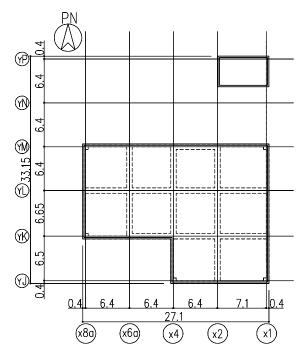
屋上階平面図 (G.L.+15.4) (単位:m)
